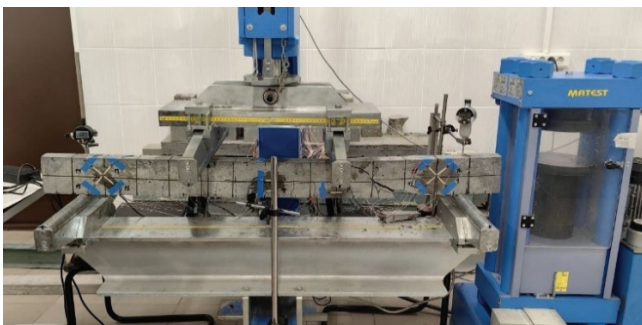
б. Железобетонная балка -ЭТ на III стадии НДС
